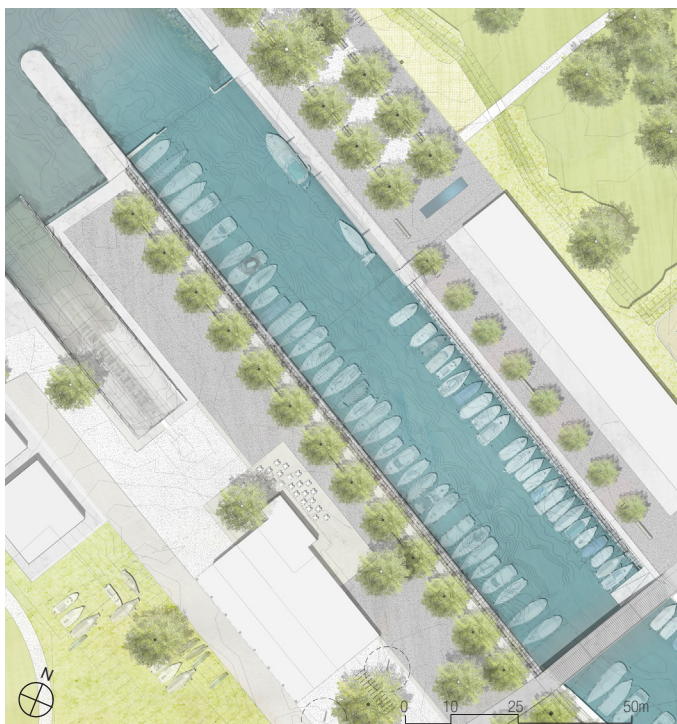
Situationsplan Ausschnitt äusseres Hafenbecken - Variante ohne Kran
